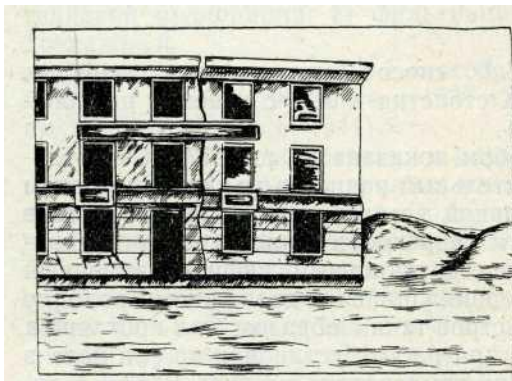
Здание, деформированное неравномерными осадками при протаивании мерзлых грунтов
